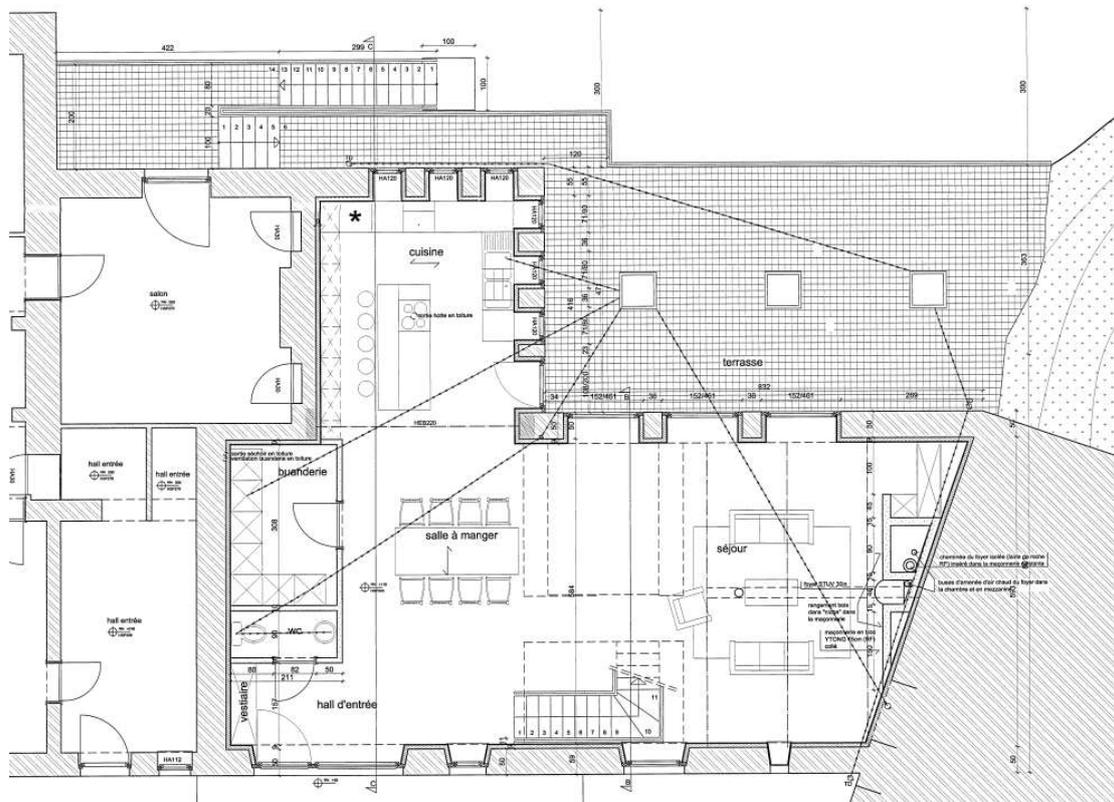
Plan du R0 de la nouvelle rénovation issu des archives du Service de l'Urbanisme de la commune de Braives
